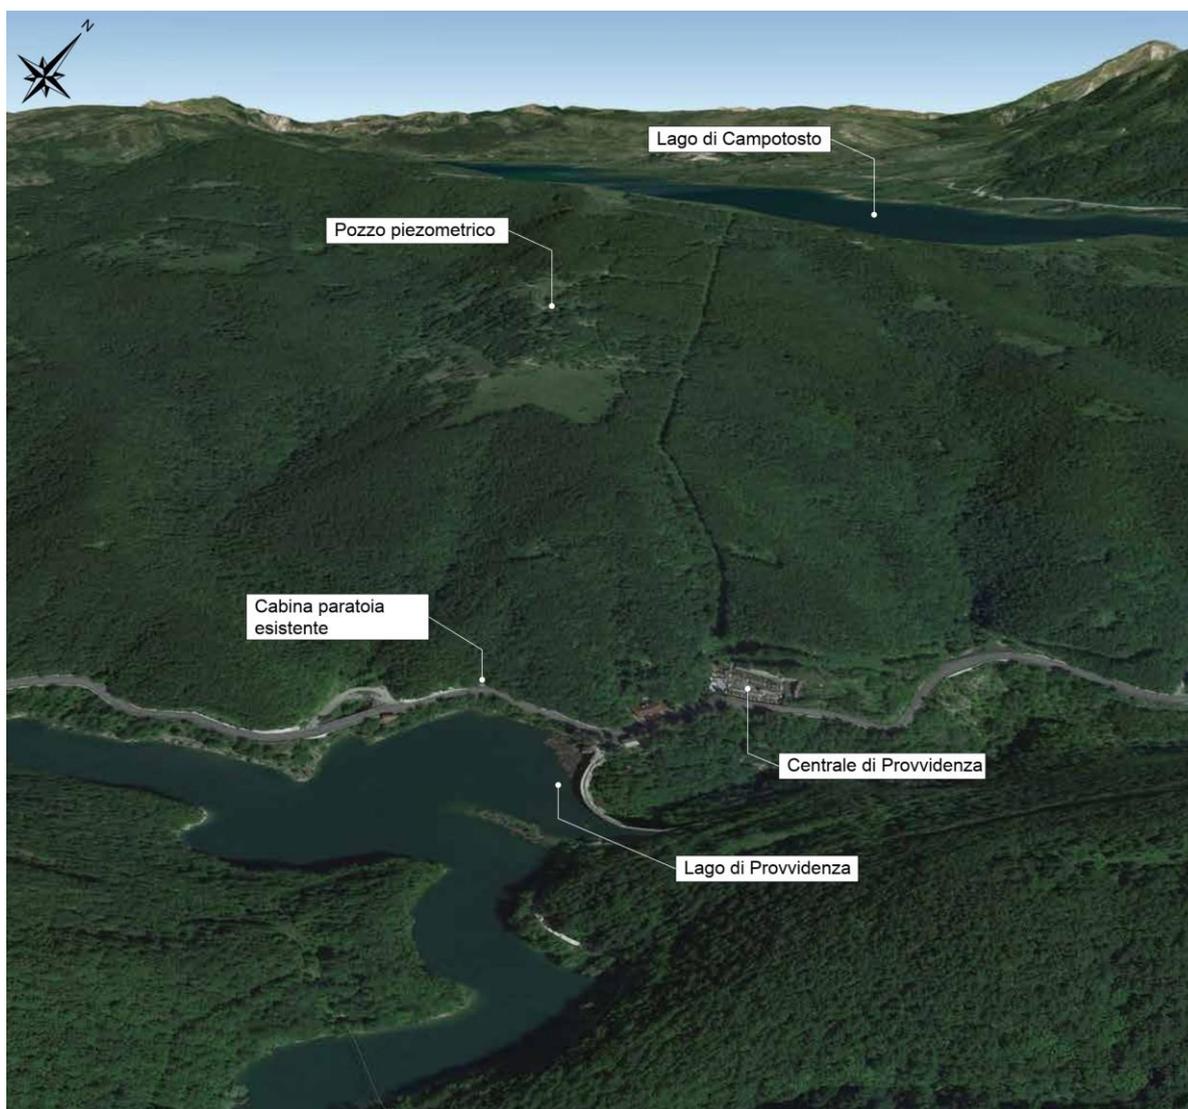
Stato di fatto – vista a volo d'uccello versante oggetto di interventi
